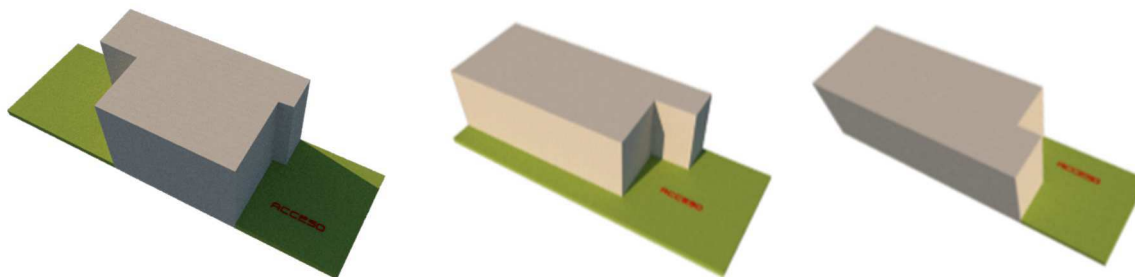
Tipologías de viviendas Mandalay. Autoría propia
